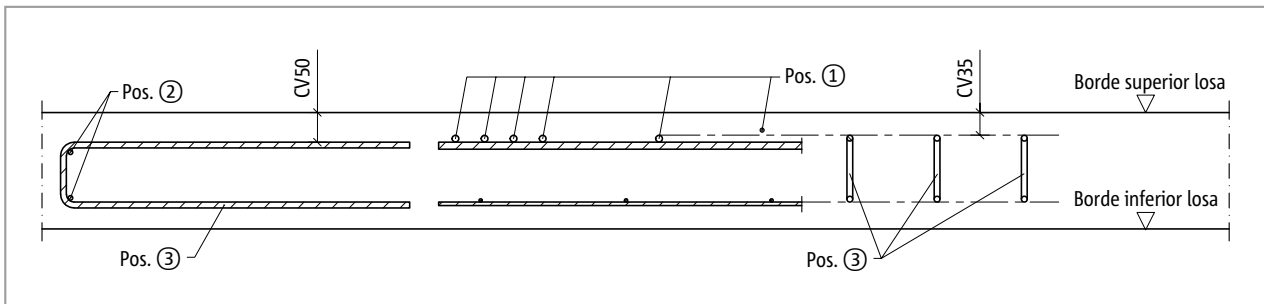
Schöck Isokorb® XT tipo C: Armadura in situ esquinero externo (sección XT tipo C-L-CV50, vista XT tipo C-R-CV35)
